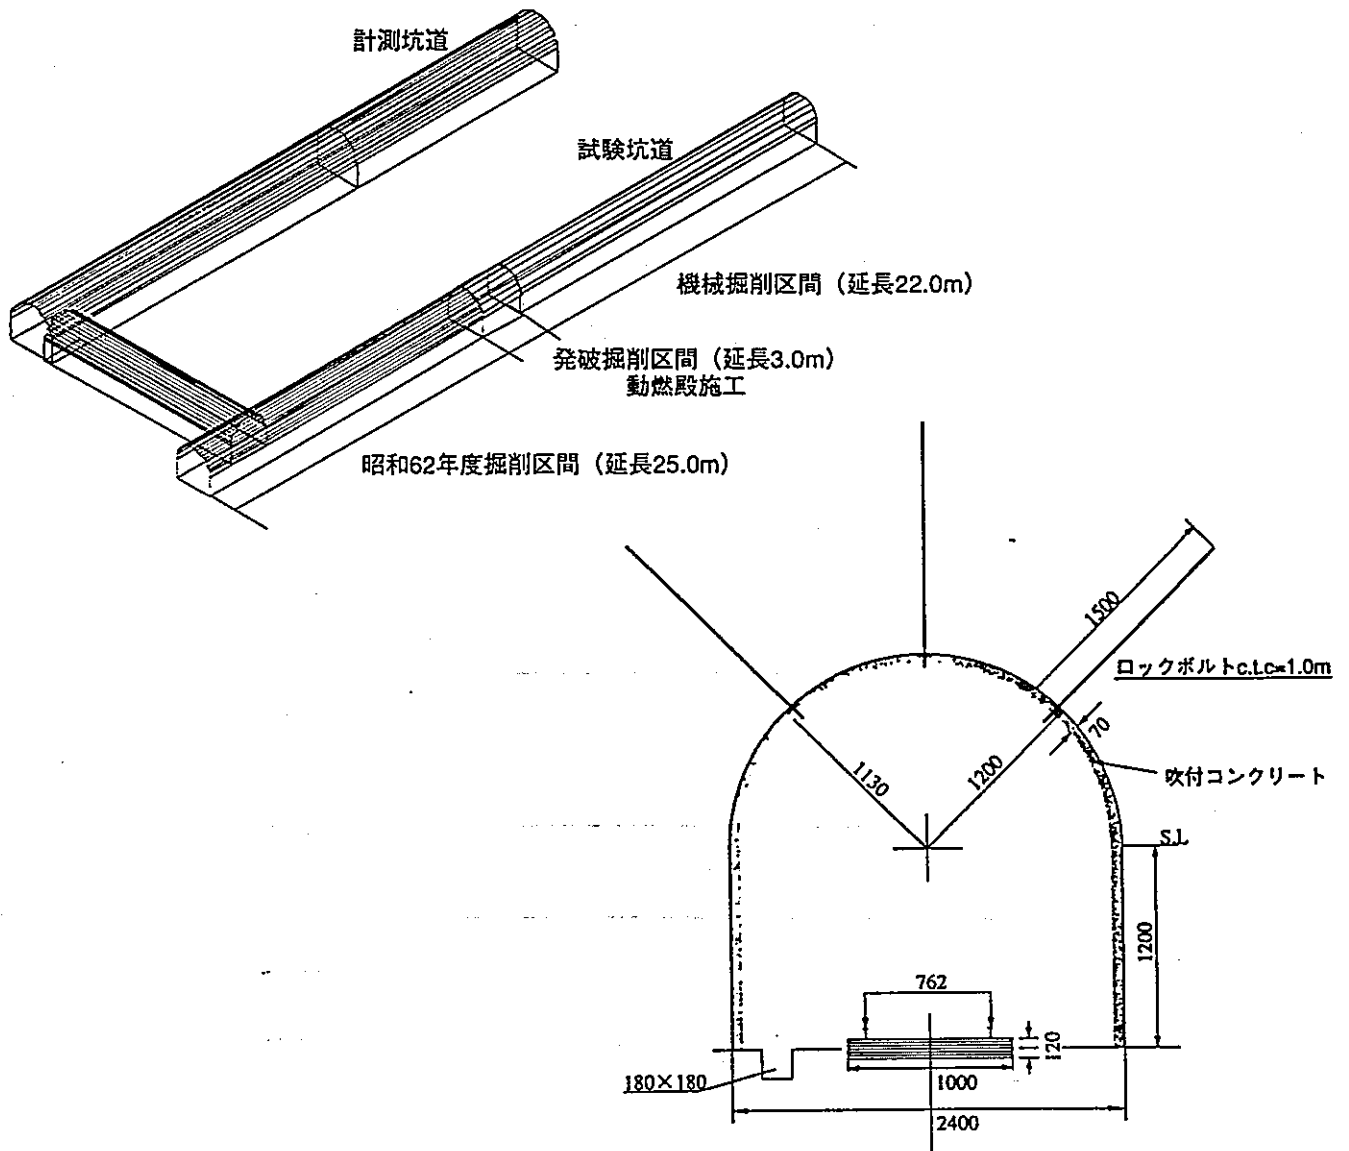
坑道掘削位置および機械掘削坑道の断面図
